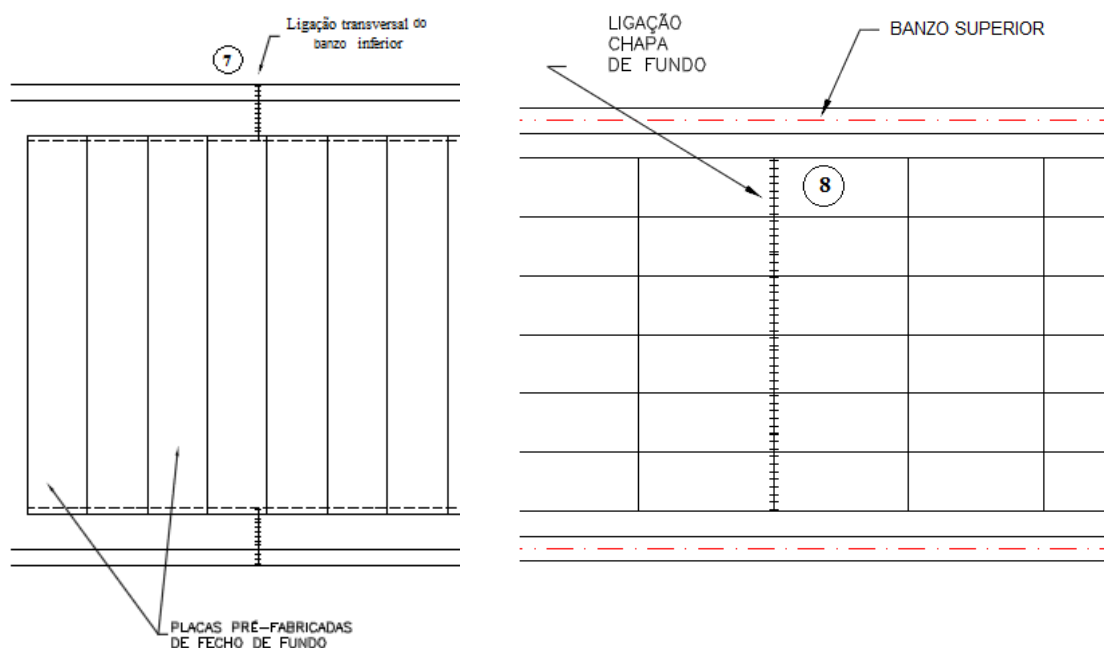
Representação em planta das ligações transversais soldadas
